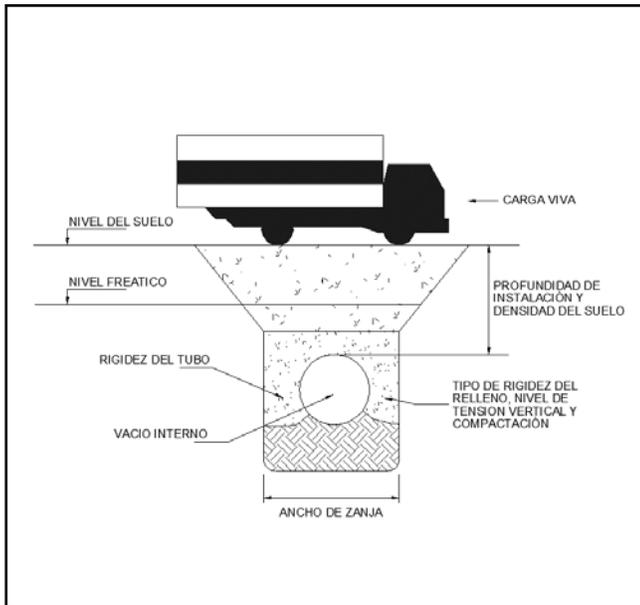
Parámetros que determinan el sistema Suelo Tubería
